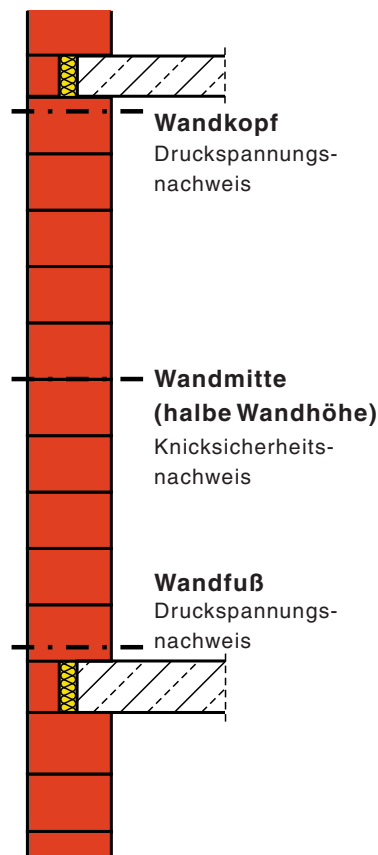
Stellen zur Nachweisführung an Mauerwerkswänden mit dem genaueren Verfahren nach DIN 1053-1
